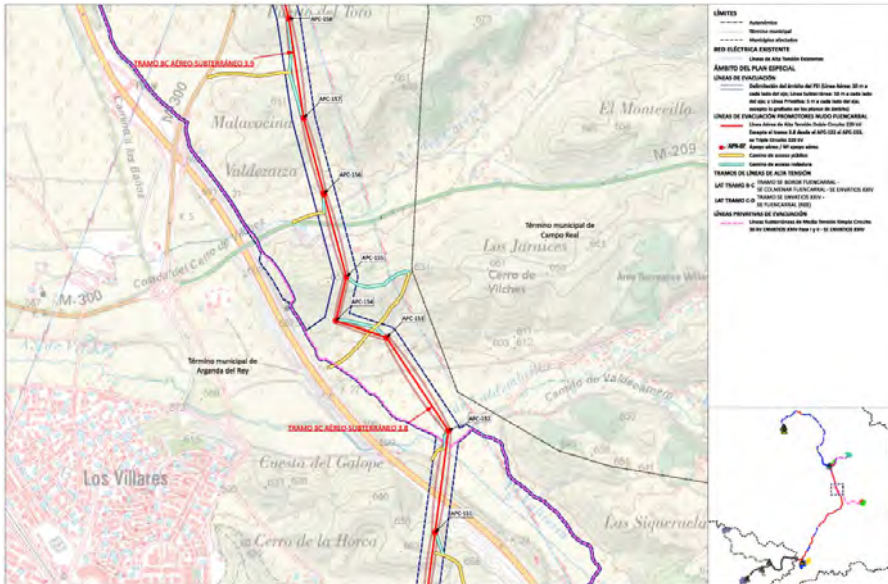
Plano de Ordenación O2.4.5. Planta por tramos. Instalaciones Envaios XXIV
